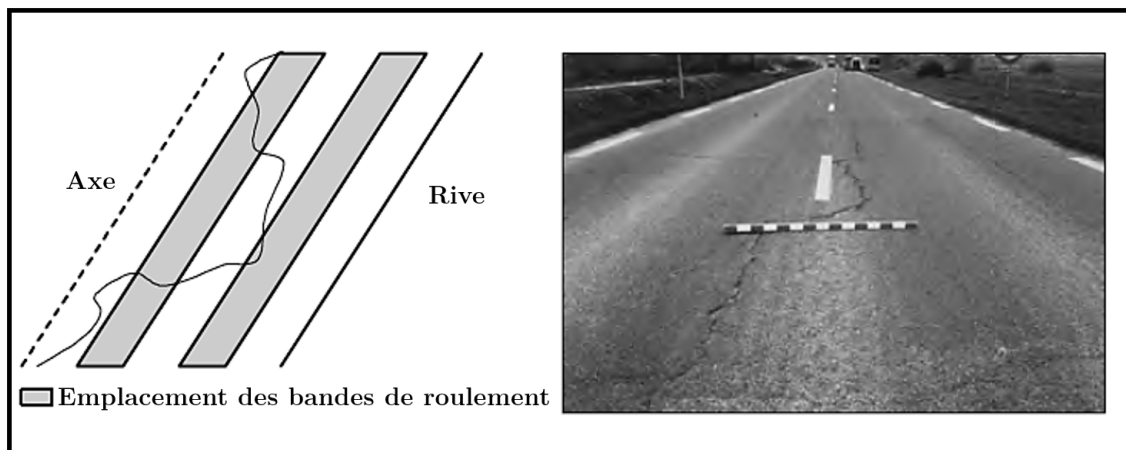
Schéma d'une fissuration longitudinale non spécifique aux bandes de roulement [Di Benedetto and Corté 2005]
